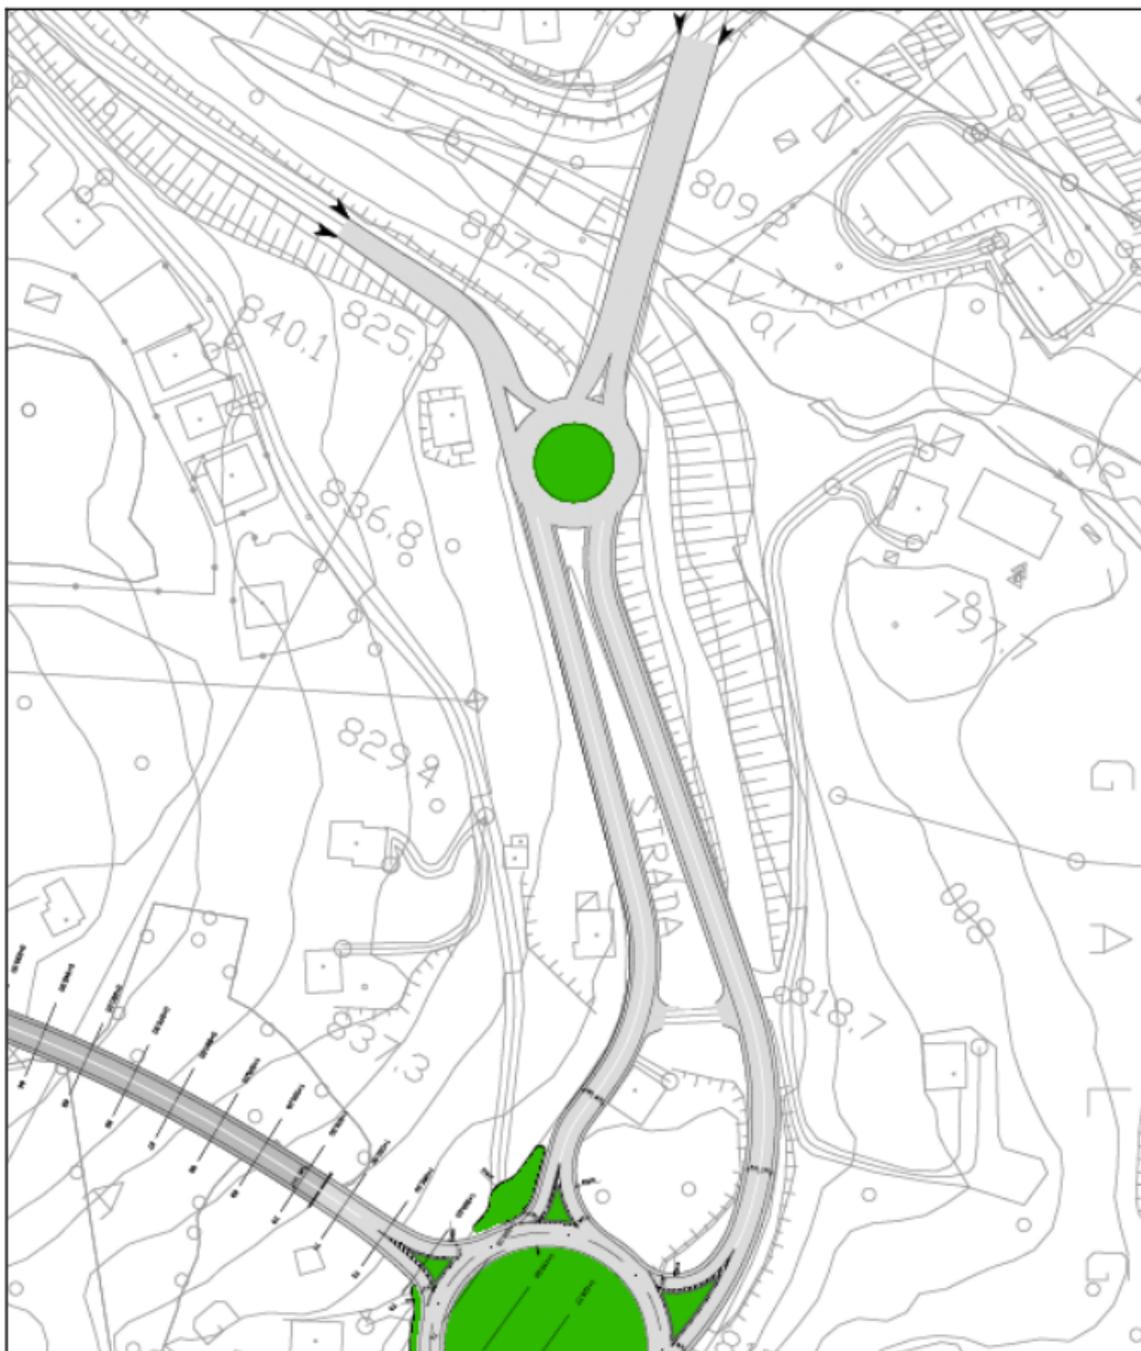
Estratto dall'elaborato T00\_EG00\_GEN\_RE01\_C (Relazione tecnica generale)
